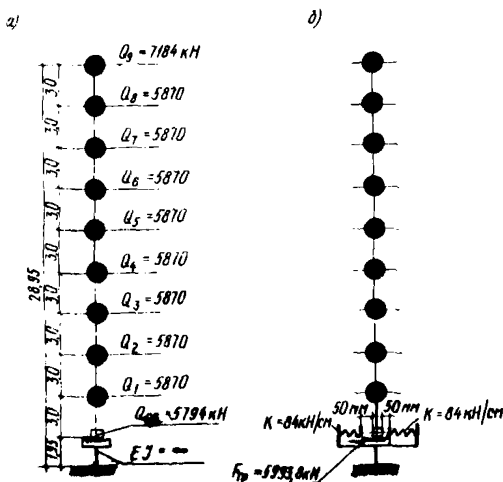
Расчетные схемы 9-этажного крупнопанельного дома с сейсмоизолирующим скользящим поясом
